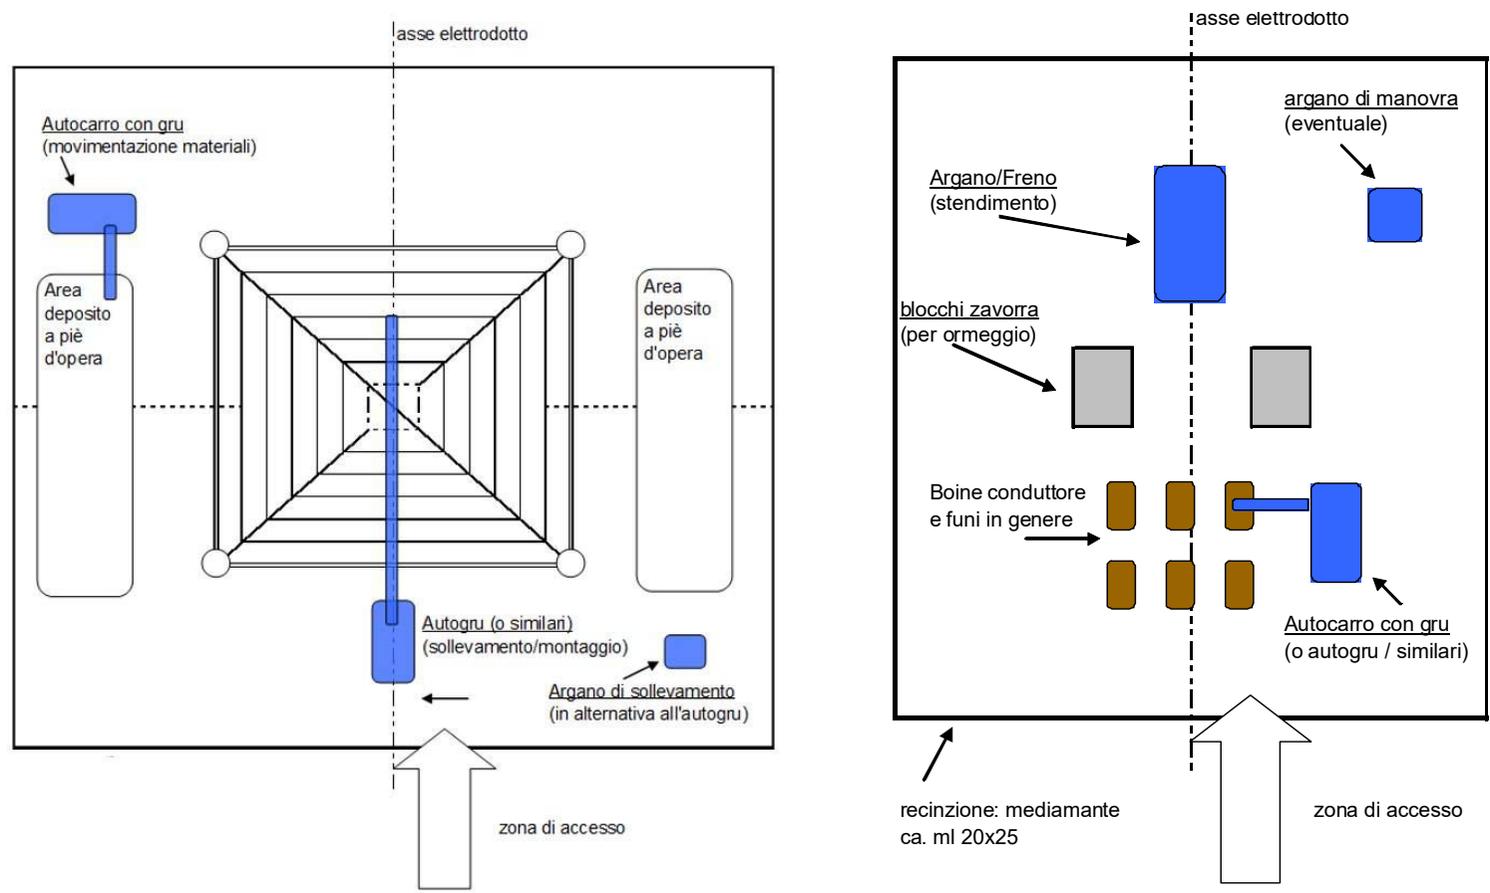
Planimetria dell'Area Sostegno (montaggio sostegno) - Planimetria dell'Area di linea - Tipologico
